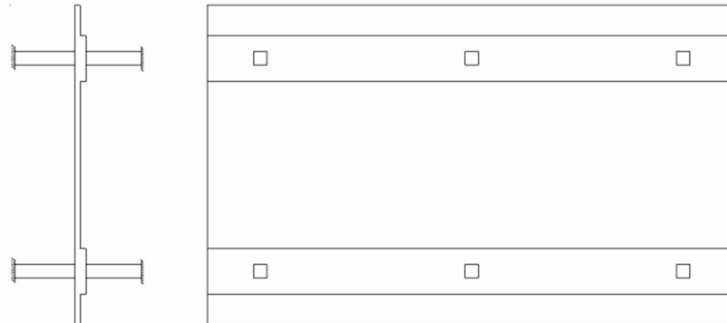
Laje lisa com engrossamento no encontro laje-pilar.
